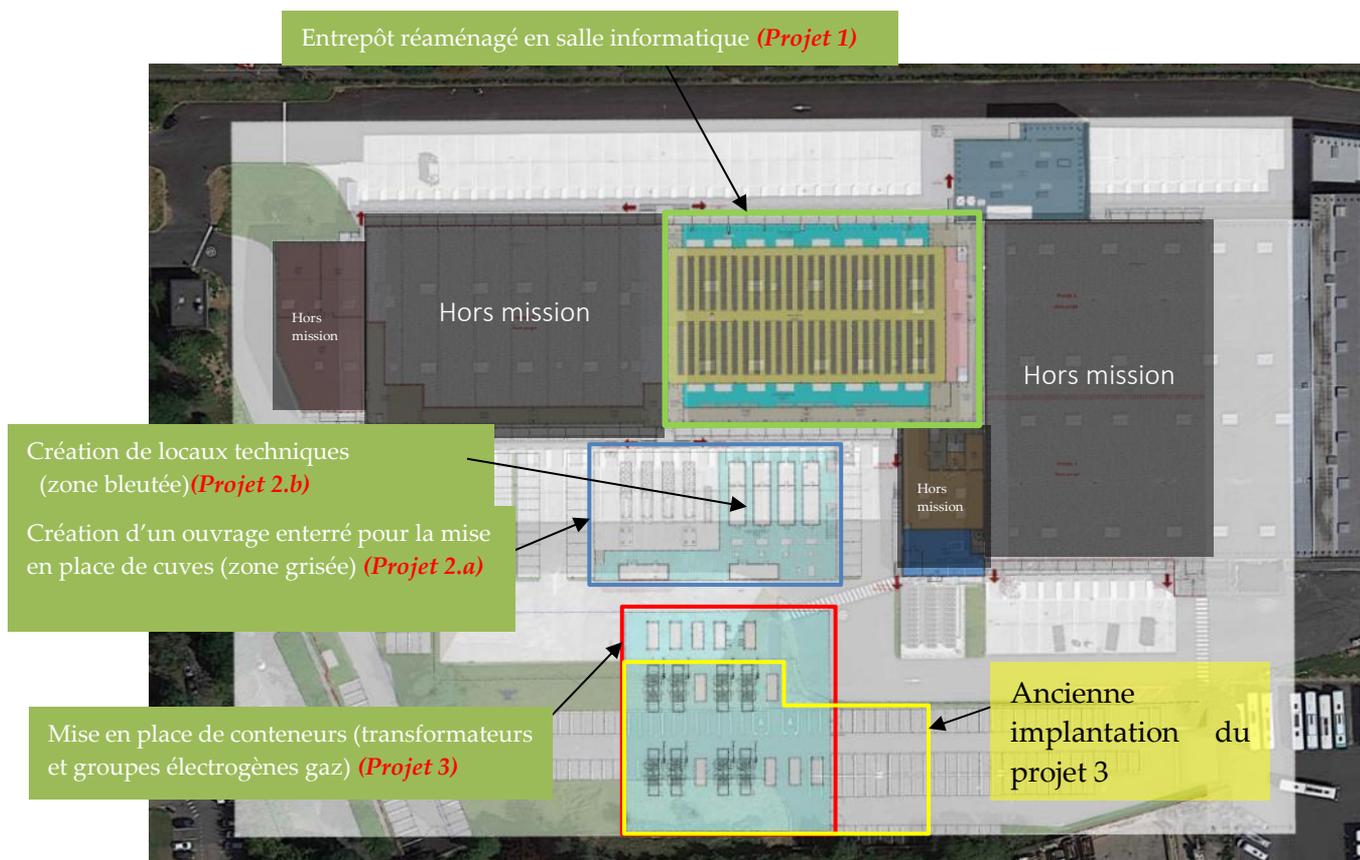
Plan de masse du projet – source : REID BREWIN ARCHITECTES
